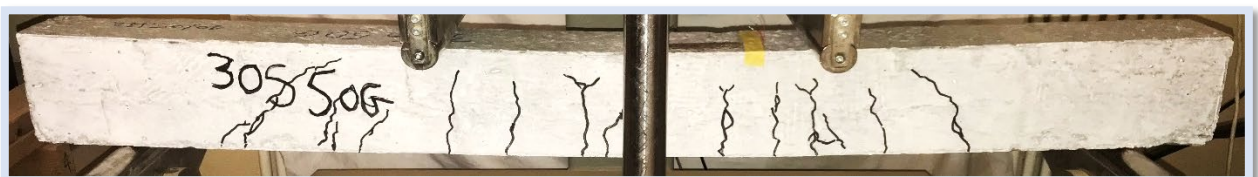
Schémas de fissuration de la poutre (BS30G50).
